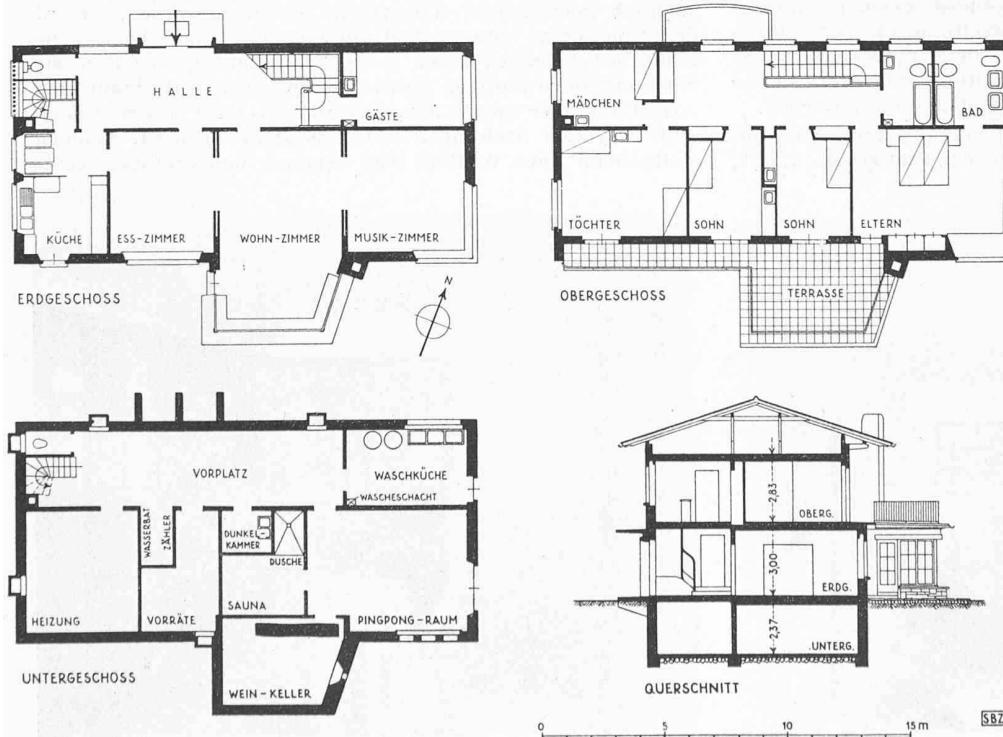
Grundrisse und Querschnitt, Maßstab 1:300
